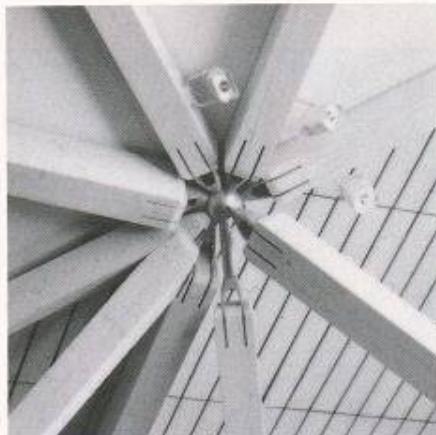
Hochbelasteter Knoten mit 9 angeschlossenen Stäben (Detail)
